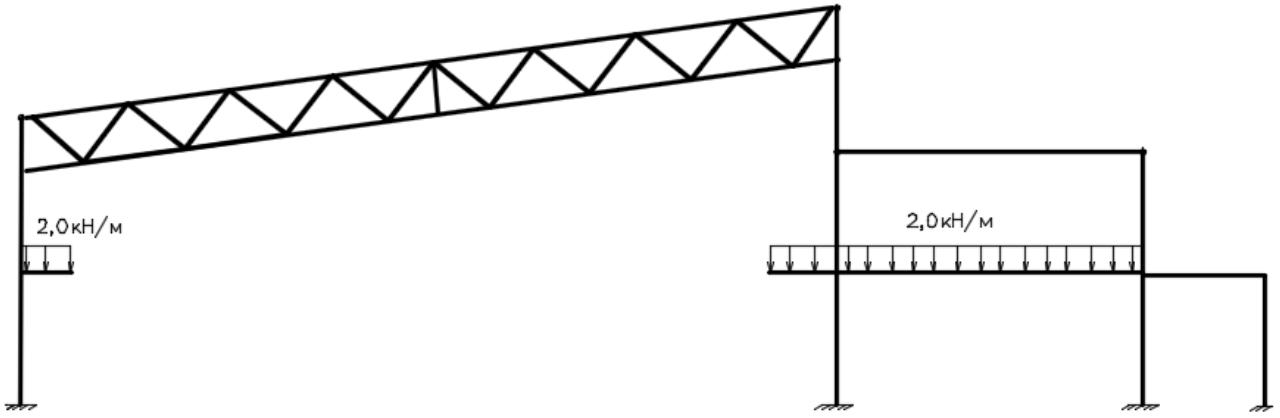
Расчетная схема для определения усилий от кратковременной нагрузки.
